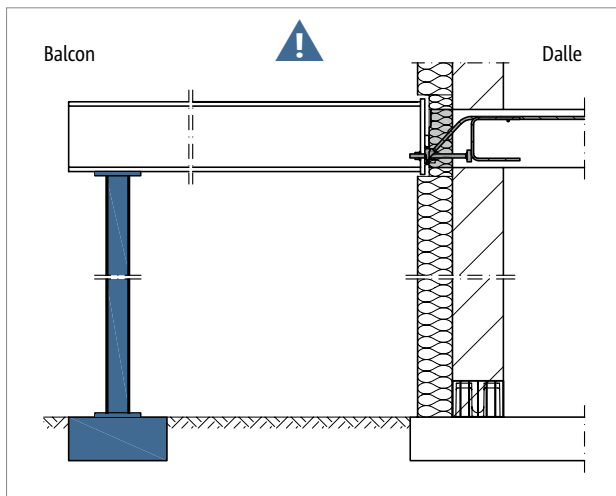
Schöck Isokorb® T type SQ : soutien continu requis
